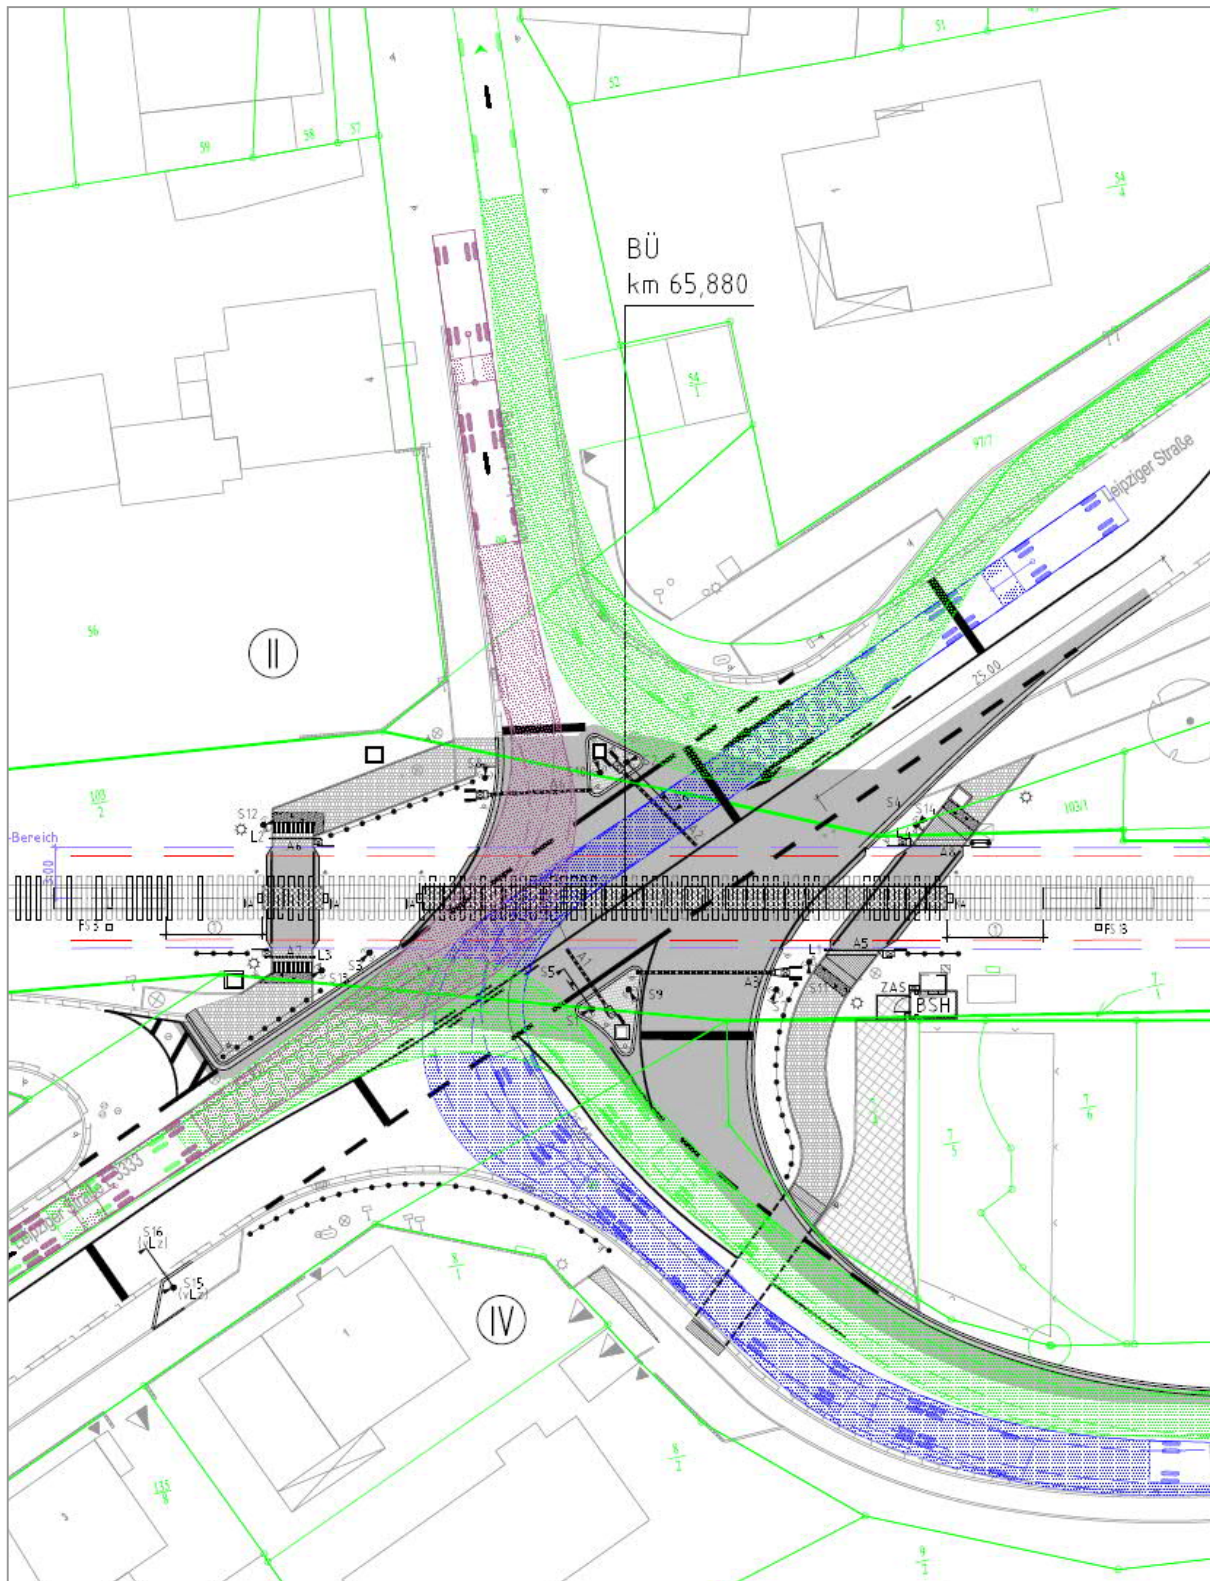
Schleppkurvenverlauf Variante 1 – Einfahrt mit 12 m langem Bus (2-Achser); Anpassungen im Gehwegbereich des nördlichen „Meerholzer Landweges“ wären erforderlich; Ausfahrt aus dem nördlichen "Meerholzer Landweg" nur Richtung Gründau (Süd-Westen) möglich
